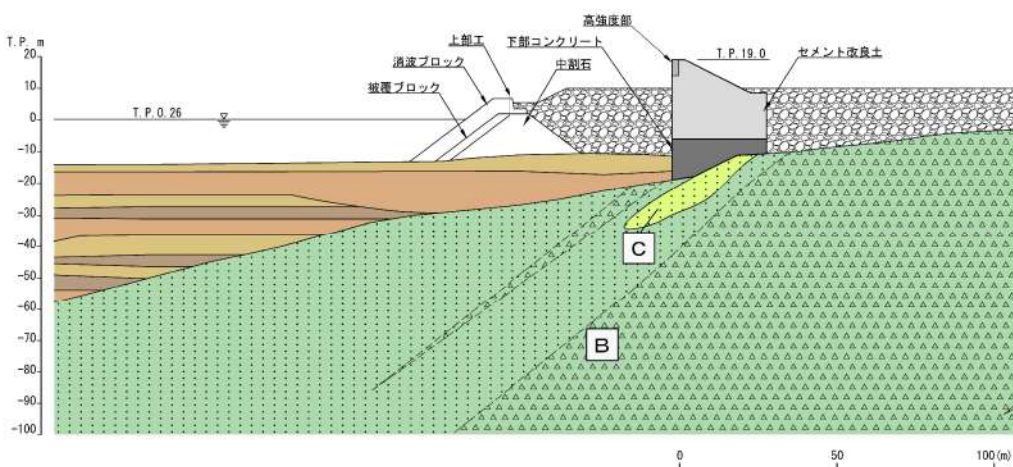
c.b-12 地質断面図 (D-D' 断面)
